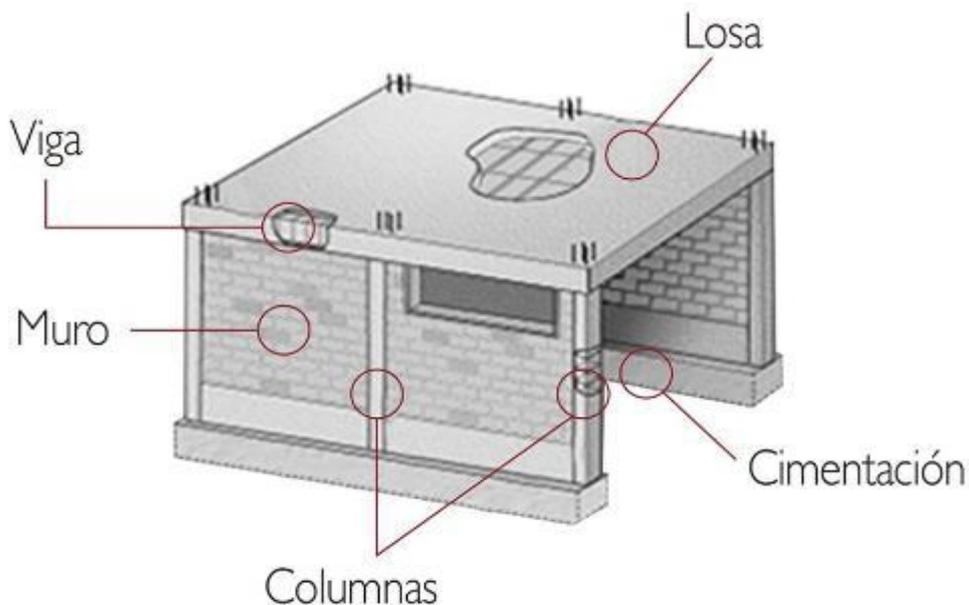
Vista de la partes de conforman la estructura de albañilería confinada.
